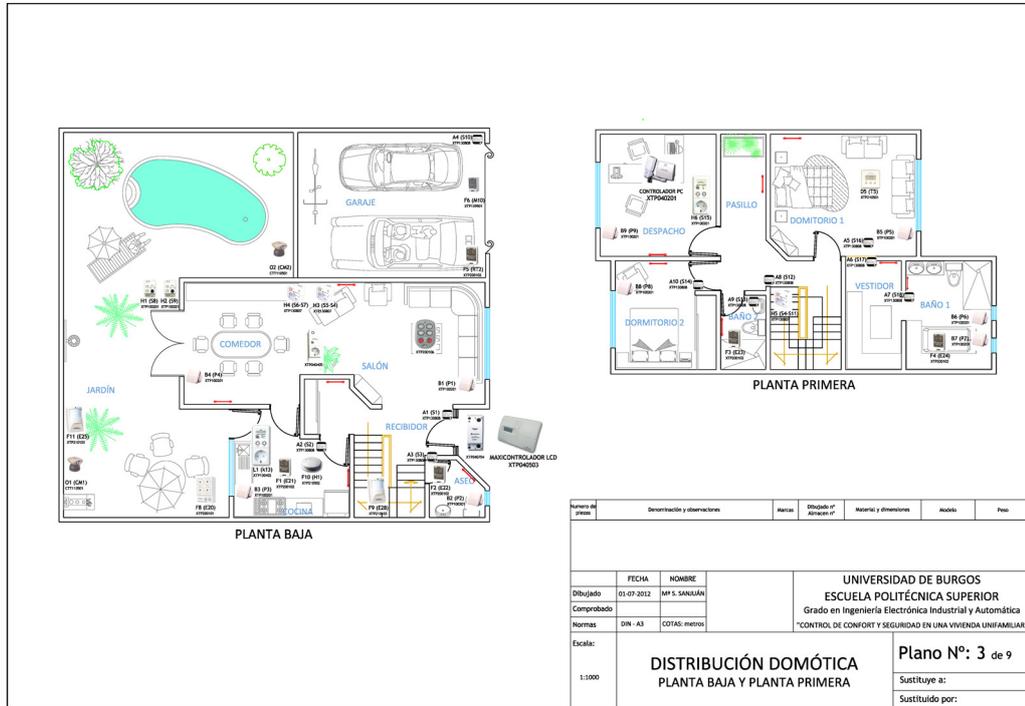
Plano nº 3. Distribución domótica. Planta baja y planta primera.
